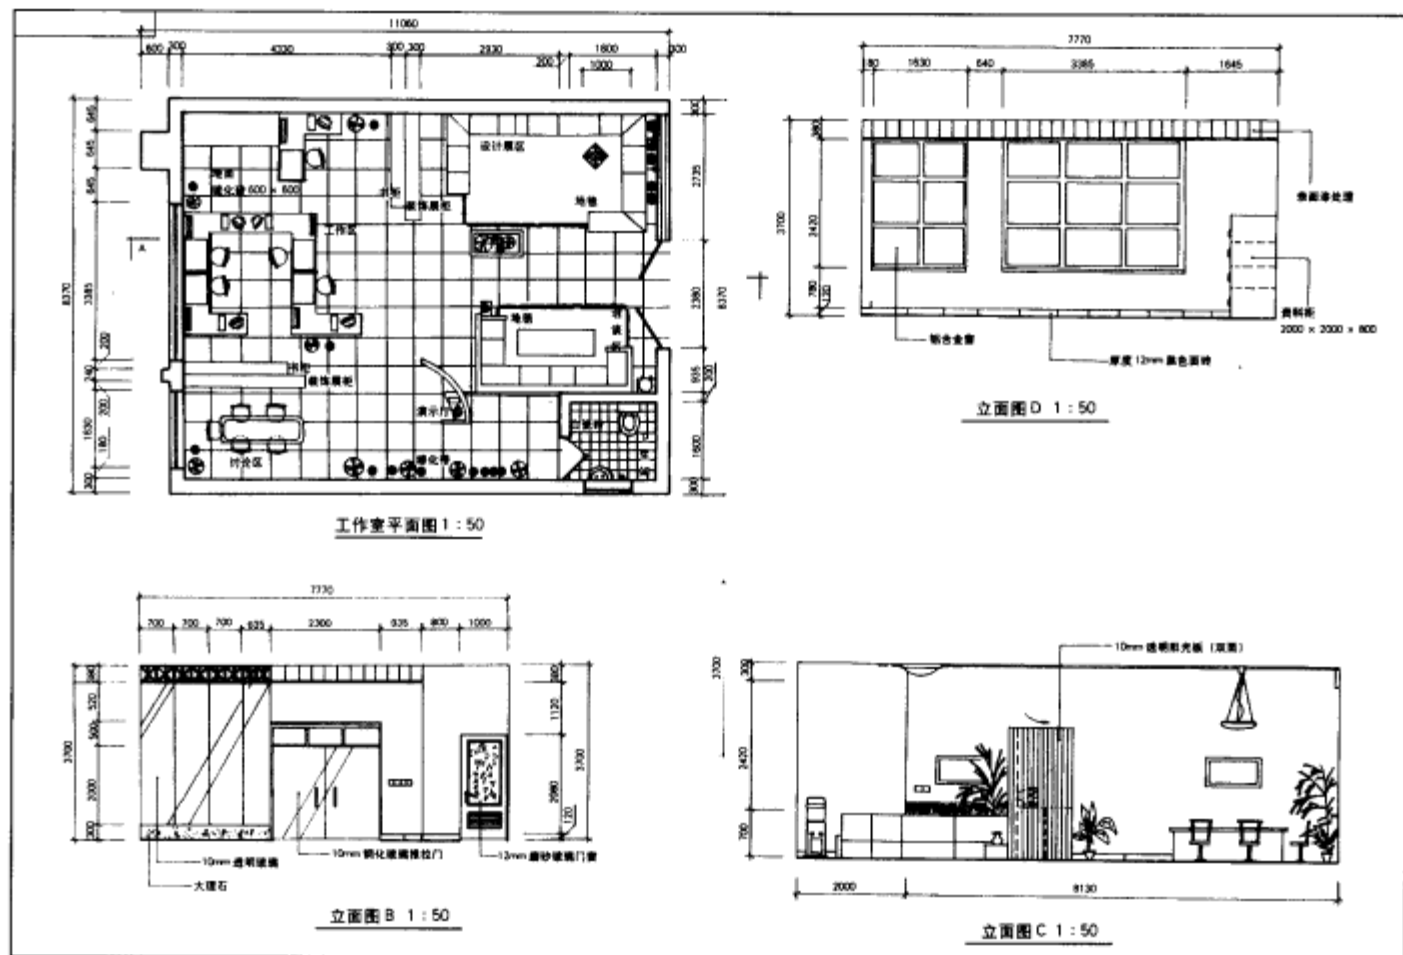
工作室设计平面图、立面图 1:30 (乔磊)
